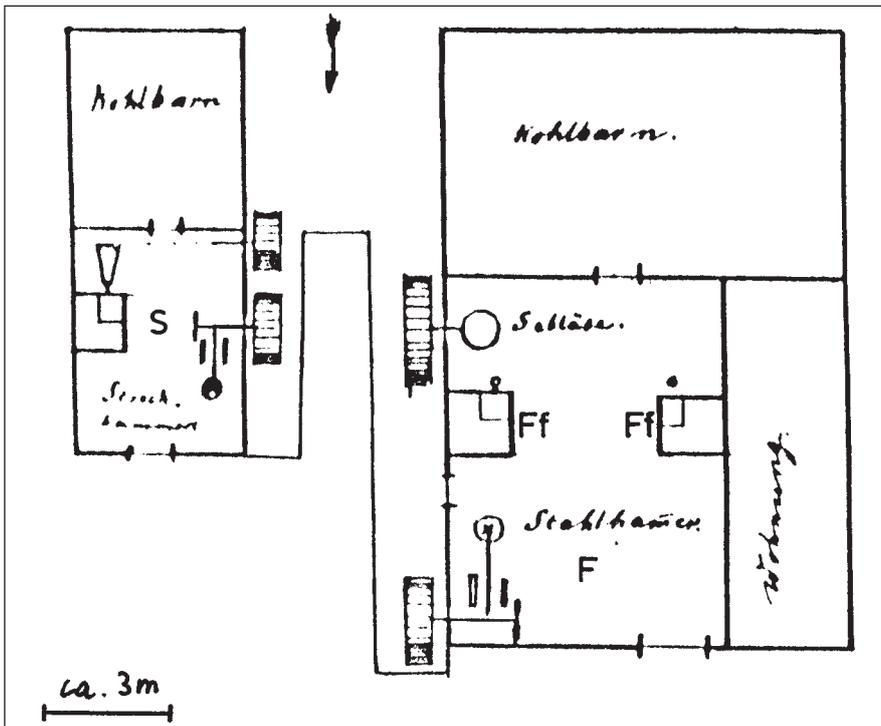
Ainbach (Knittelfeld). Grundriss des Hammerwerkes der Gewerken Forcher 1852 (Gewerkschaft Ainbach). Rechts: Frischhütte (Stahlerzeugung), links: Streckhammer.
